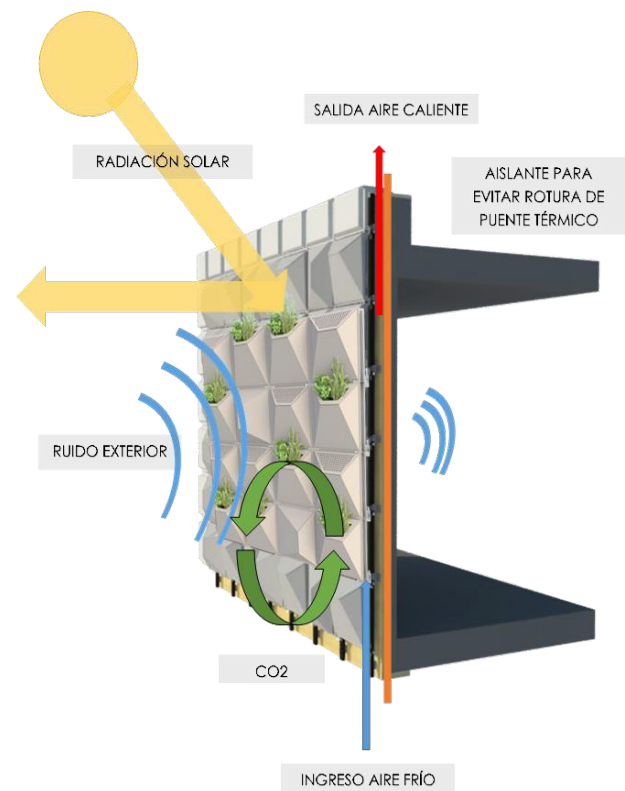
Fachada ventilada PRISART adaptada a muros ciegos. Fuente: Elaboración Propia.
